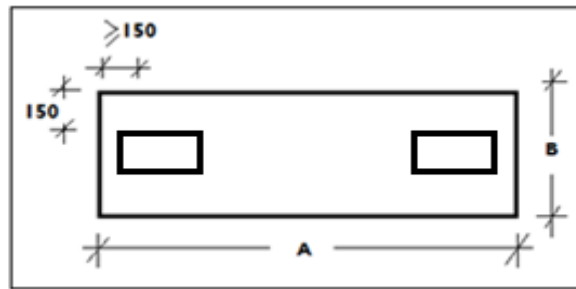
Vue en plan de la semelle sur 2 pieux.
